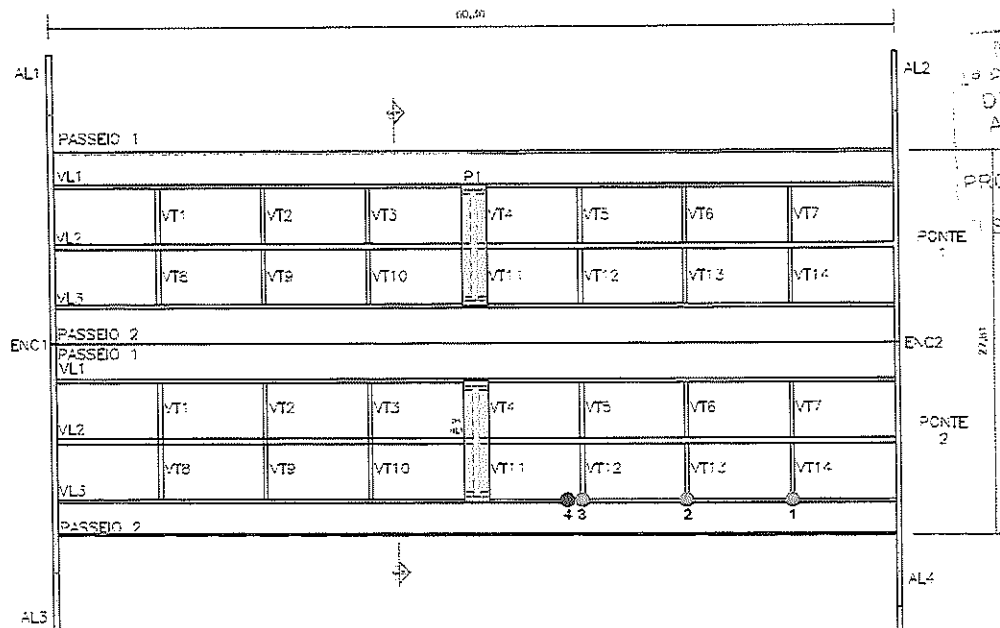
Pontos de monitoramento para a Configuração 2 – vista em planta
